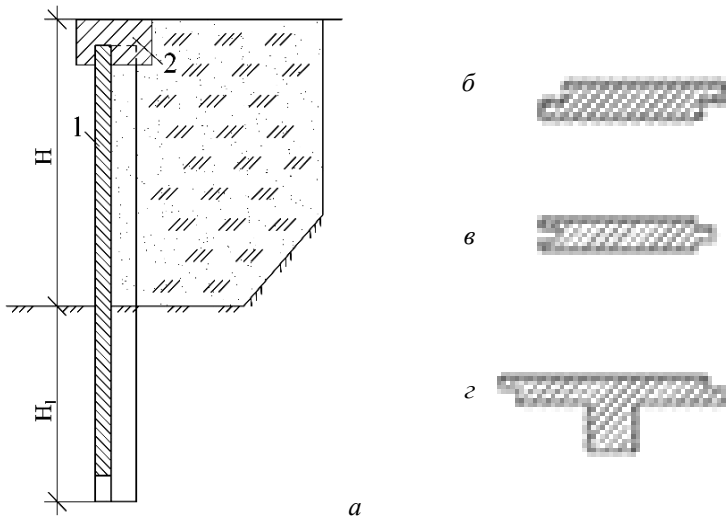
Конструкция шпунтовой безанкерной стены:
